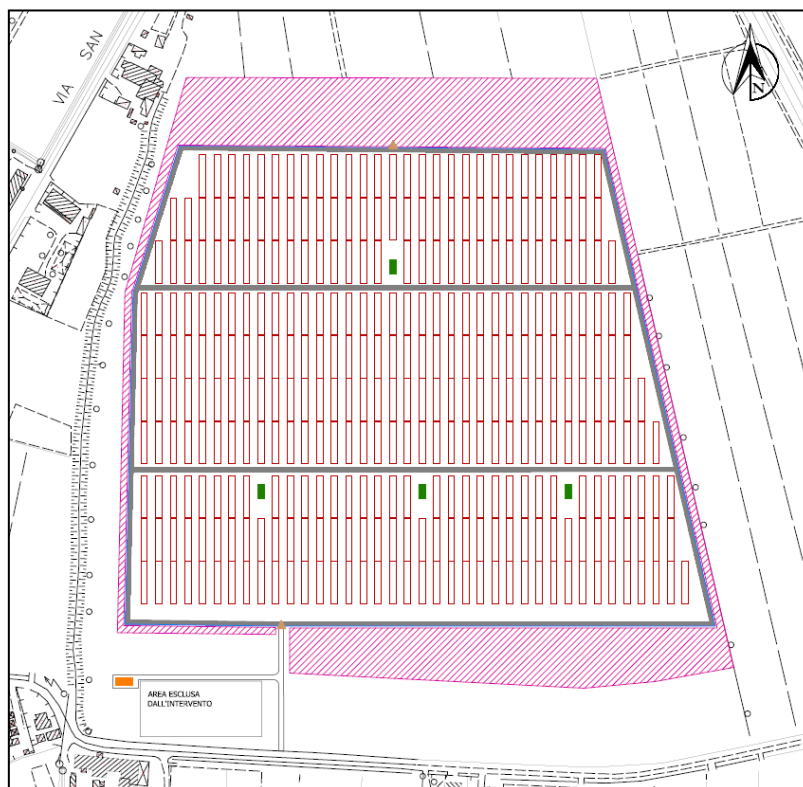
Layout generale dell'impianto fotovoltaico – alternativa prescelta
